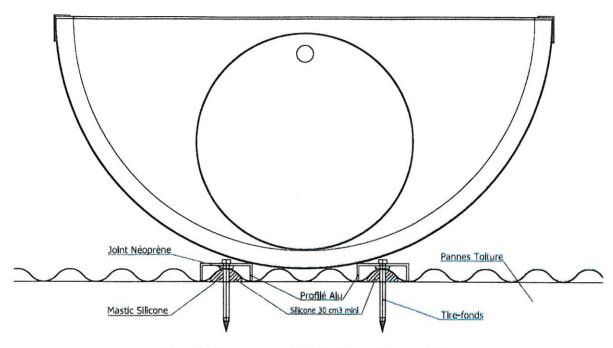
Vue en coupe de la fixation sur tôles ondulées.
